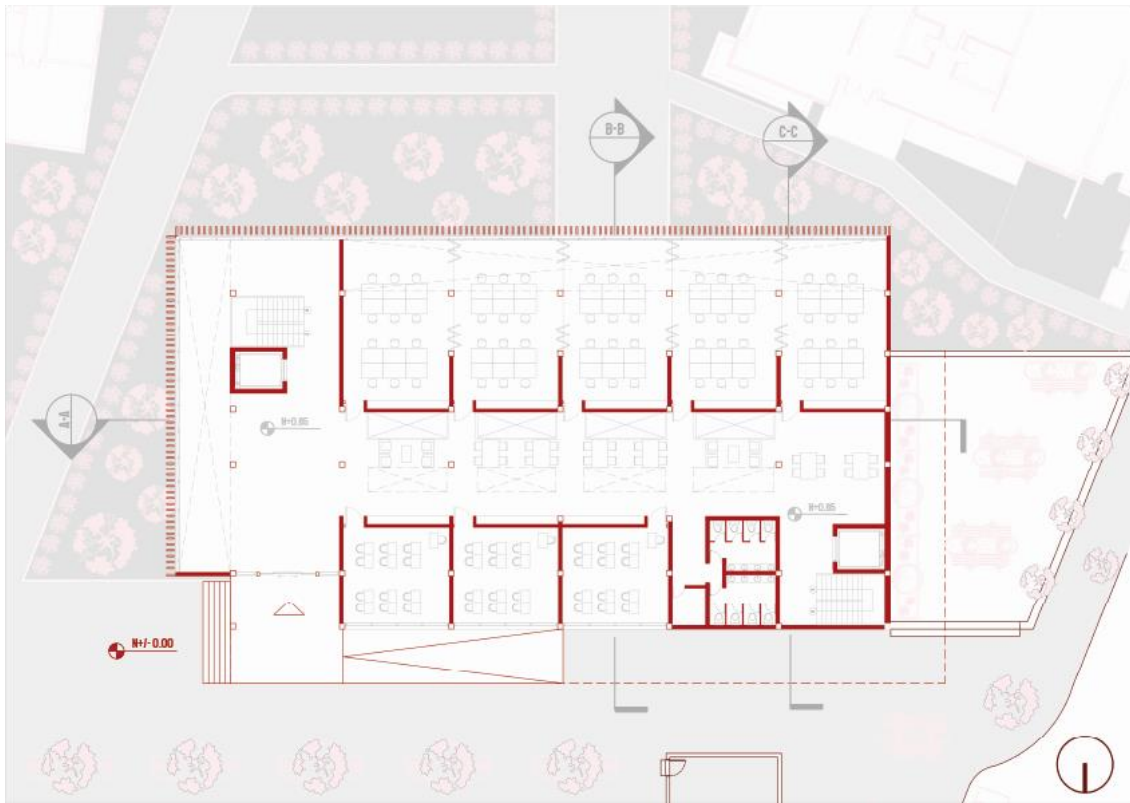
Planta Baja N+/-0.00. Ilustración del autor
